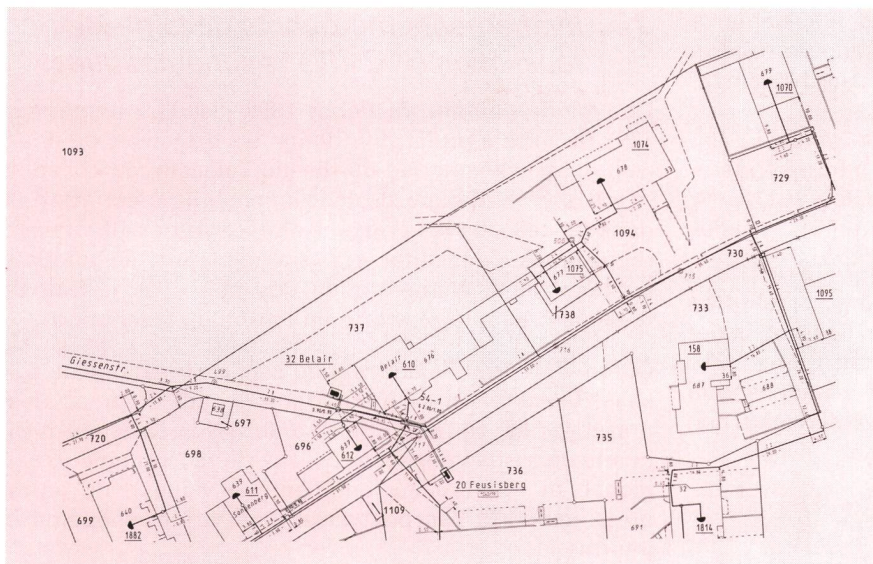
Ausschnitt eines Situationsplans der Pilot-Fernmeldedirektion Rapperswil – Extrait d'un plan de situation établi par la Direction des télécommunications pilote de Rapperswil
